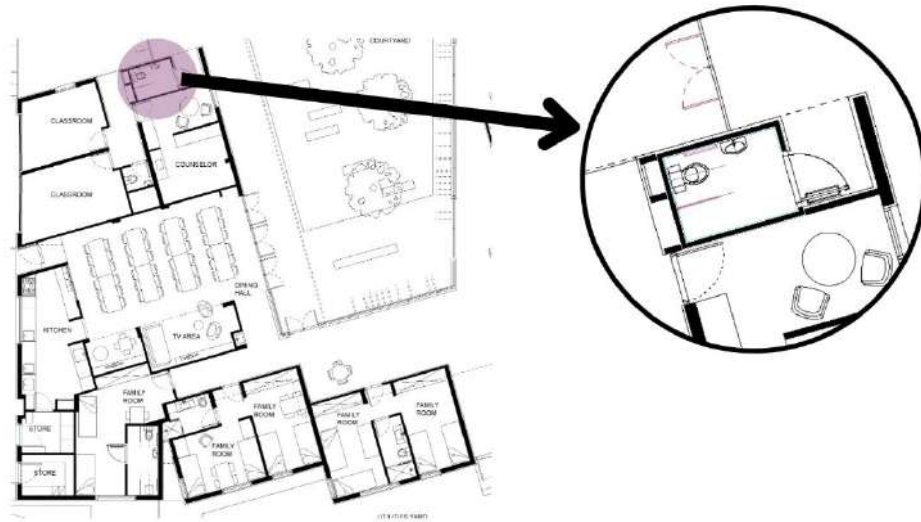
Recorte do único banheiro PCD do abrigo. Fonte: Modificado de ArchDaily (2018).
